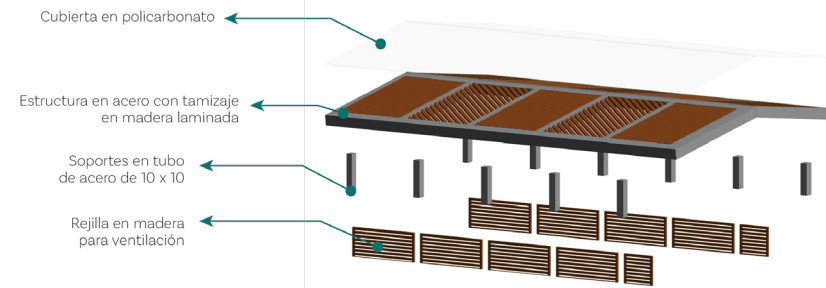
Estructura de cubierta de espacio central y circulaciones
